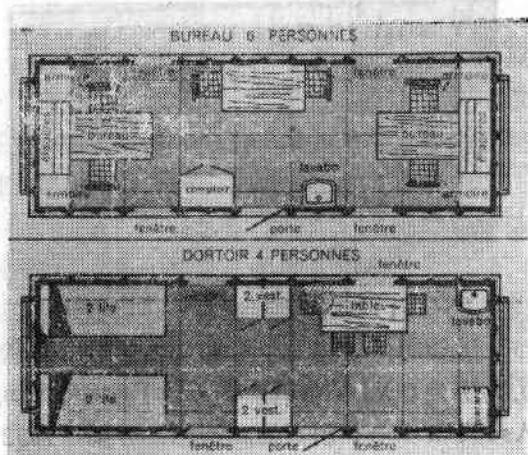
法国活动房屋平面图。上面布置为办公室，下面布置为宿舍。
